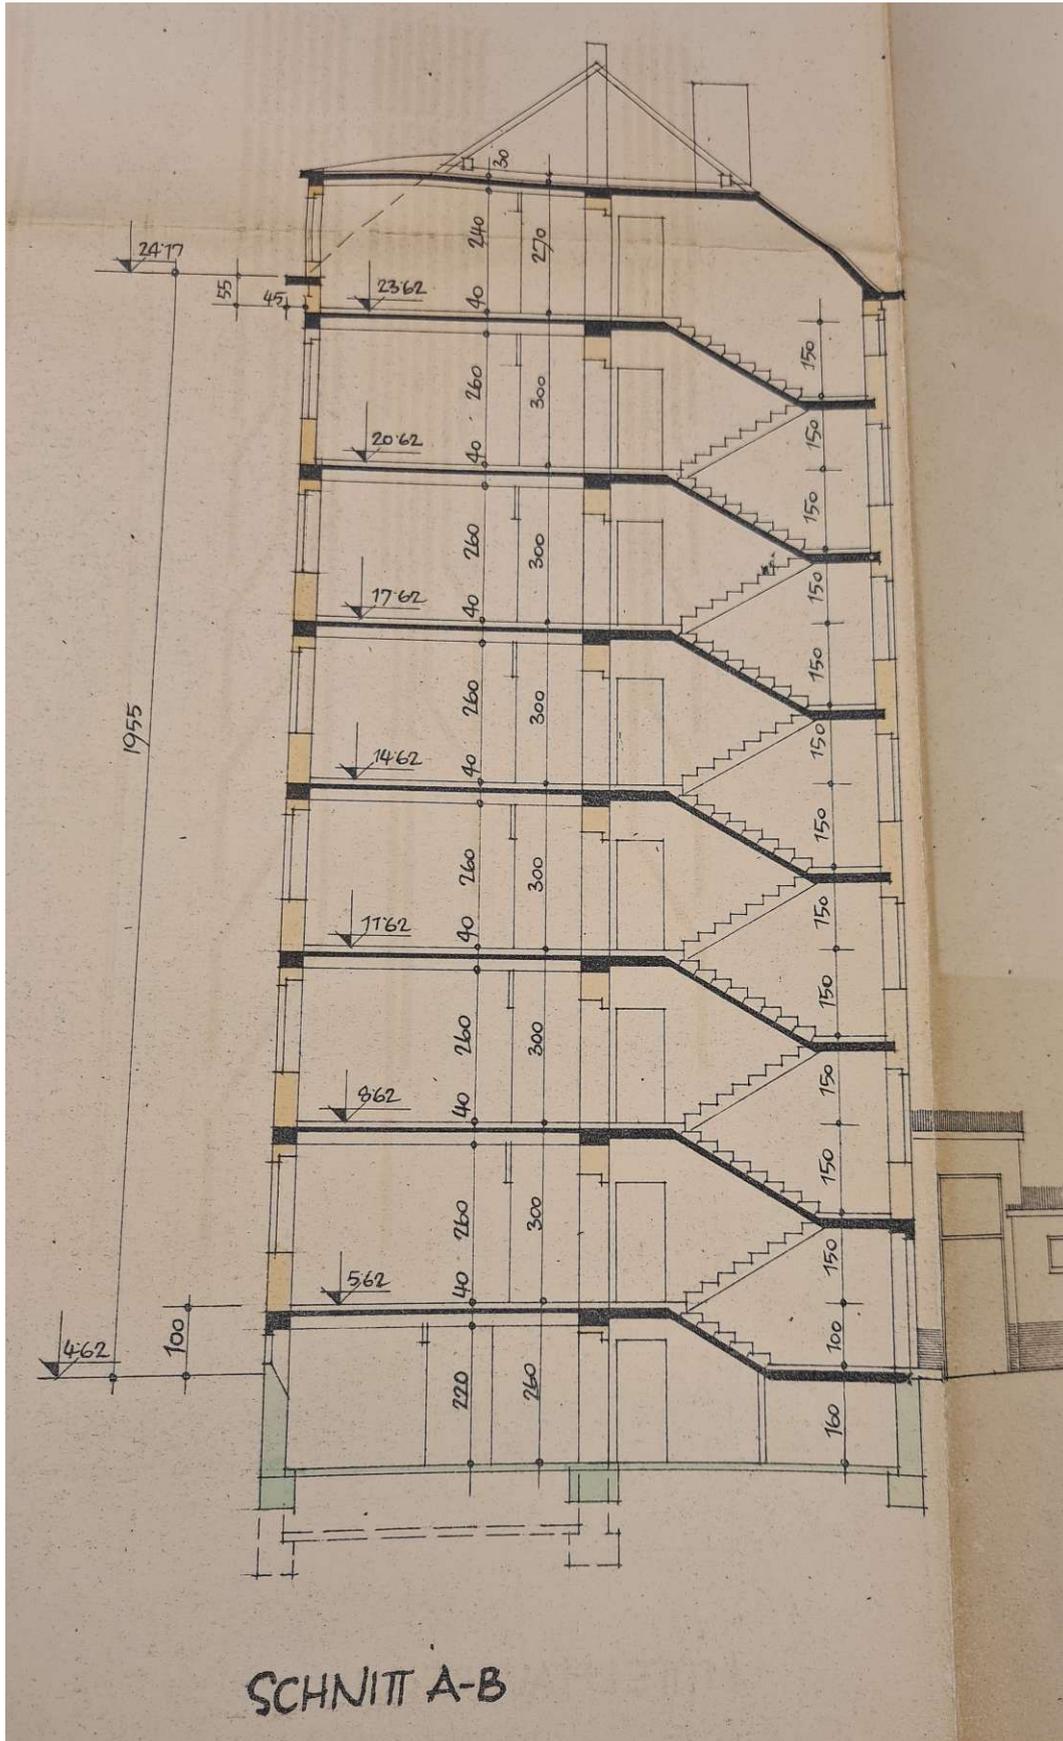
Ausstellungsstraße 67 - Schnitt Stiege 1, Bestandsplan 1955
